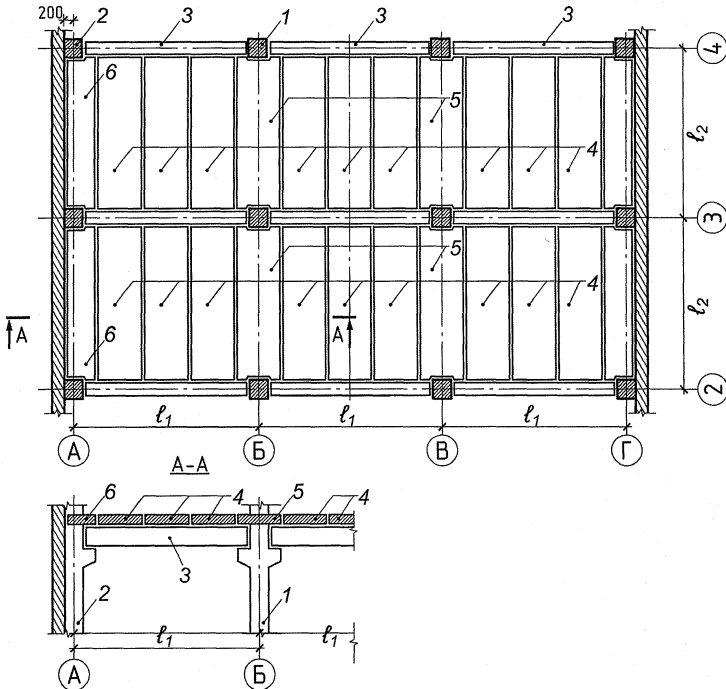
Сборное железобетонное перекрытие здания с несущим каркасом:
